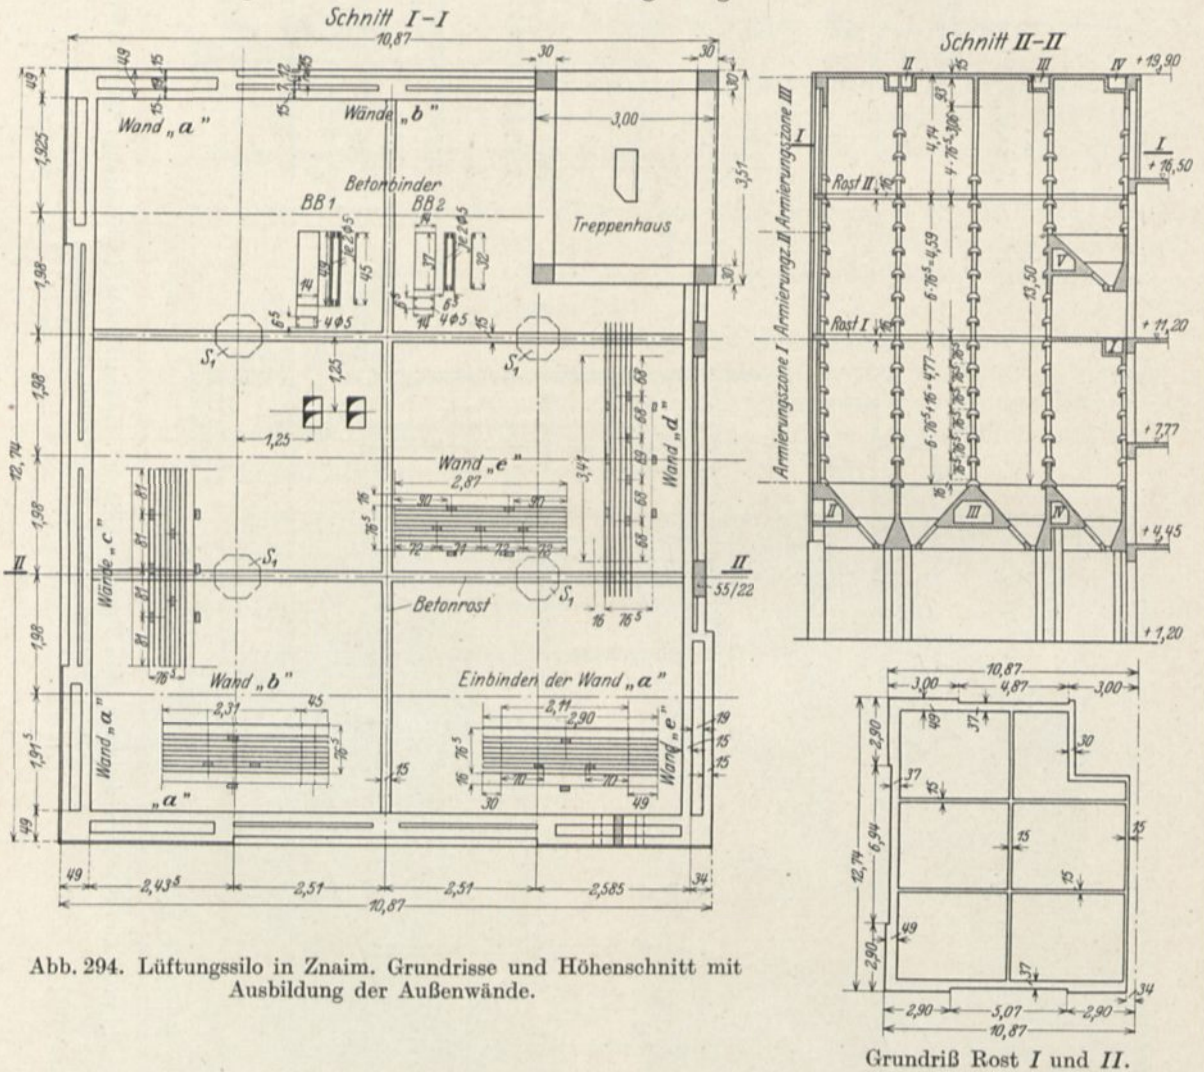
Lüftungssilo in Znaim. Grundrisse und Höhenschnitt mit Ausbildung der Außenwände.
